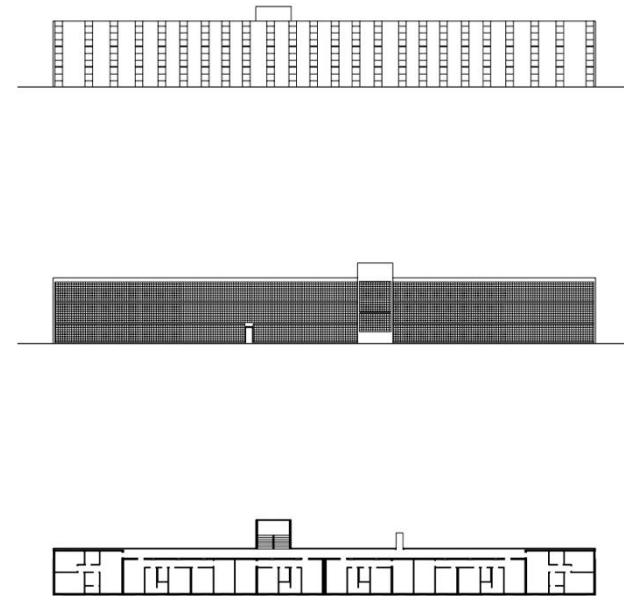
Fachadas e planta do bloco AP-05. Fonte: Ferreira e Gorovitz (2020)
